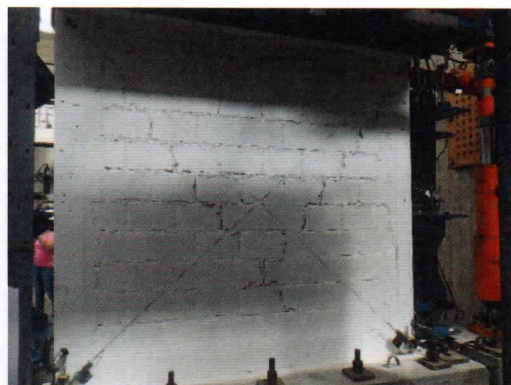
Formación de grietas diagonales en el mortero hasta la parte central del muro para una distorsión 1/1100. Vista cara Norte.
